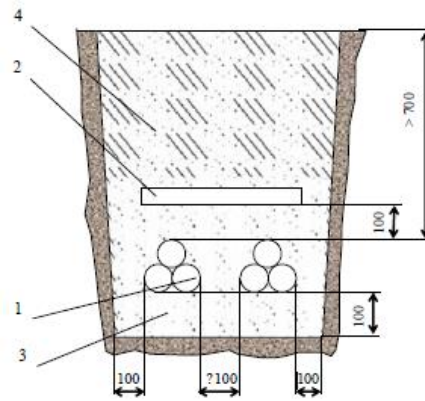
1 - кабель 10 кВ; 2 - залізобетонна плита; 3 – піщано – гравійна суміш; 4 - засипний ґрунт
